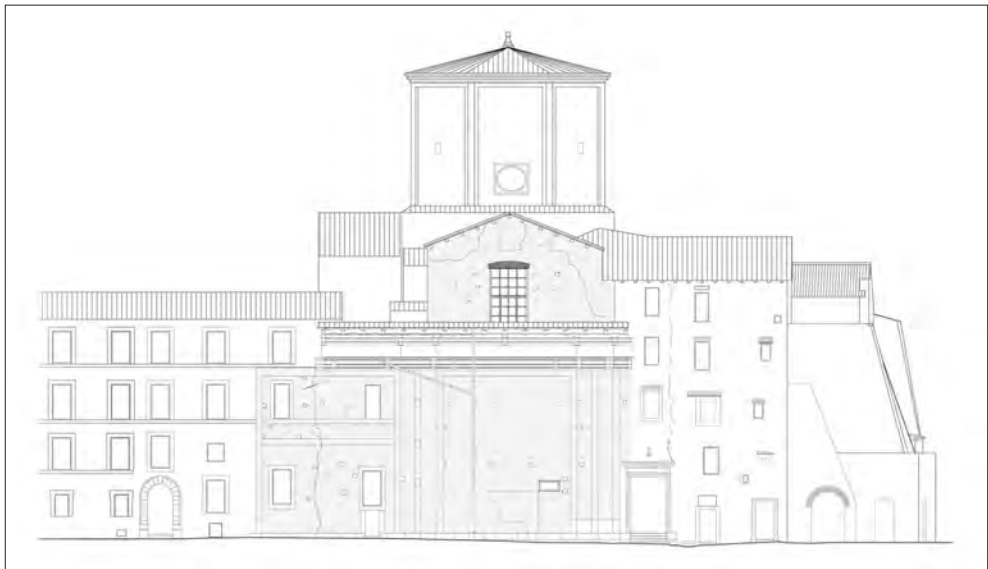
Prospetto di parte dell'isolato in cui è collocata la chiesa Santa Maria del Pianto, lungo via di Santa Maria de' Calderari (rilievo di A. Giacopello, 2012; originale in scala 1:100).
